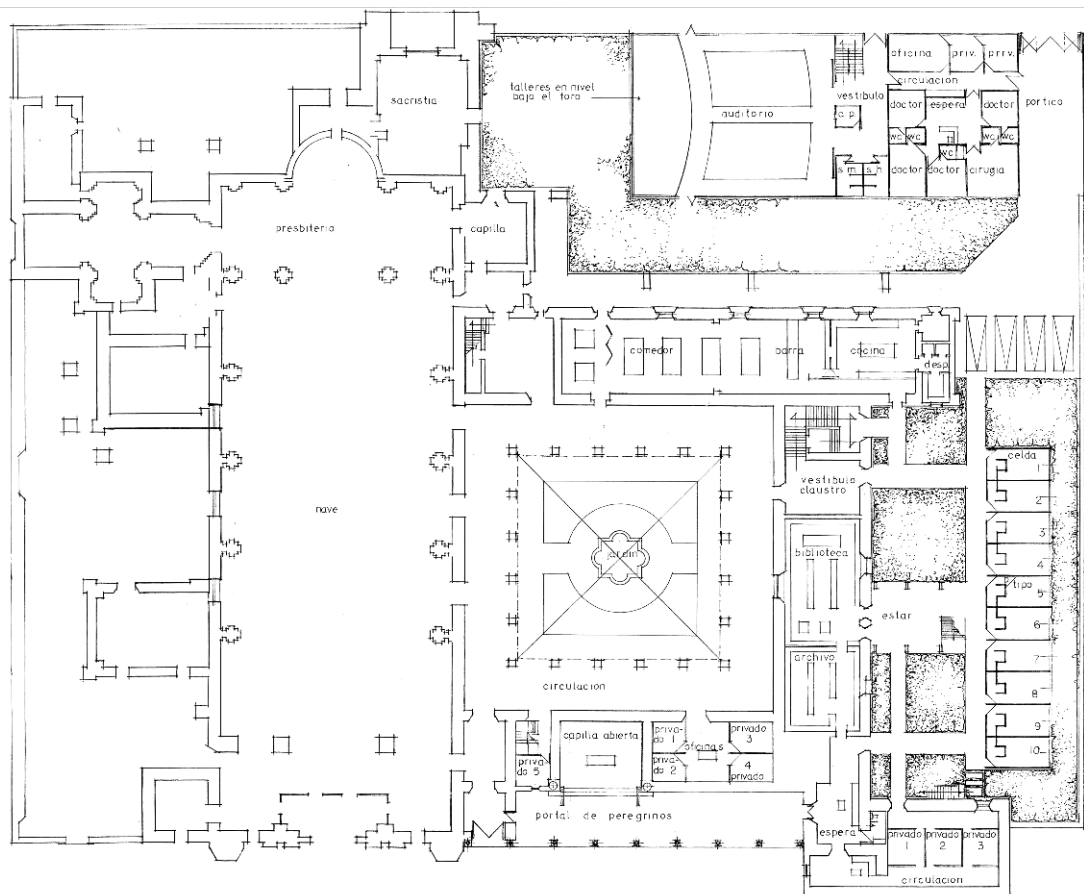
Levantamiento realizado para el proyecto de restauración y adaptación para el convento de San Juan Bautista, planta segundo nivel (planta alta), agosto de 1968.⁶⁹²
